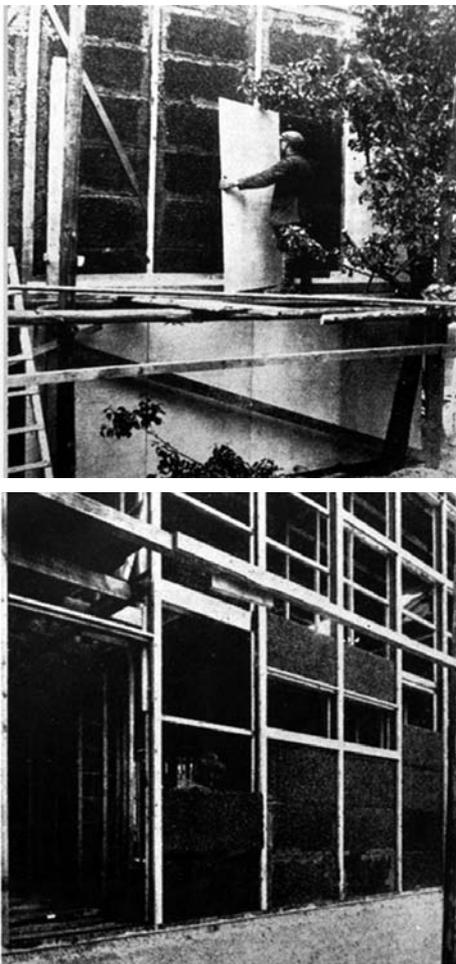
DETALLES CONSTRUCTIVOS PUBLICADOS EN BERICH ÜBER DIE SIEDLUNG IN STUTTGART AM WEISSENHOF, 1929. VISTAS DURANTE LA CONSTRUCCIÓN DEL CERRAMIENTO DE FACHADA DE LA VIVIENDA 17, BRGA, 1927.
